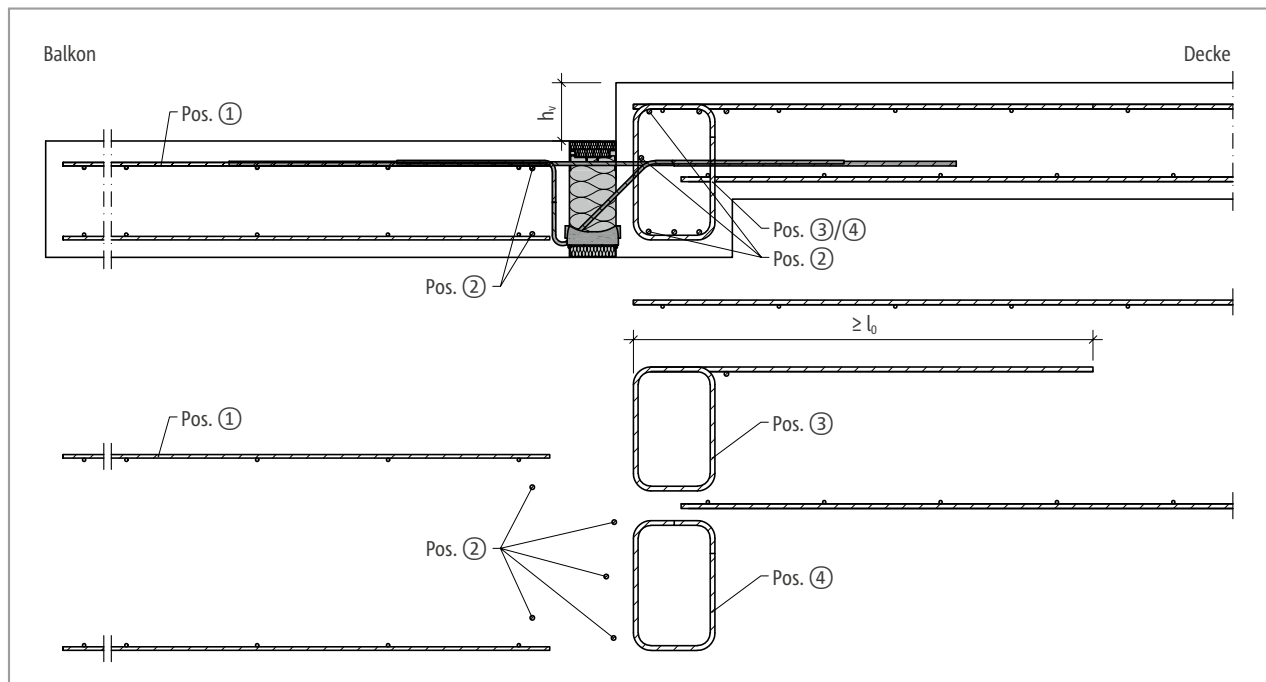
Schöck Isokorb® T Typ K: Bauseitige Bewehrung für kleinen Höhenversatz
